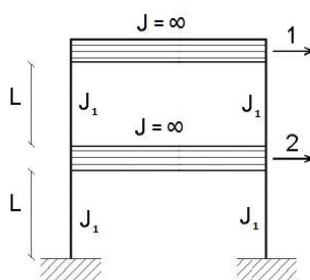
Modelo de Pórtico Plano de dois Andares (*Shear Building*).
